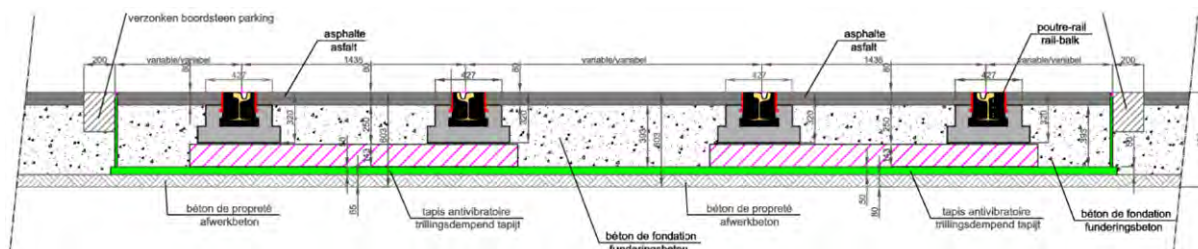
Coupe de principe poutres-rails (variante dalle flottante) (D2S, 2018)
